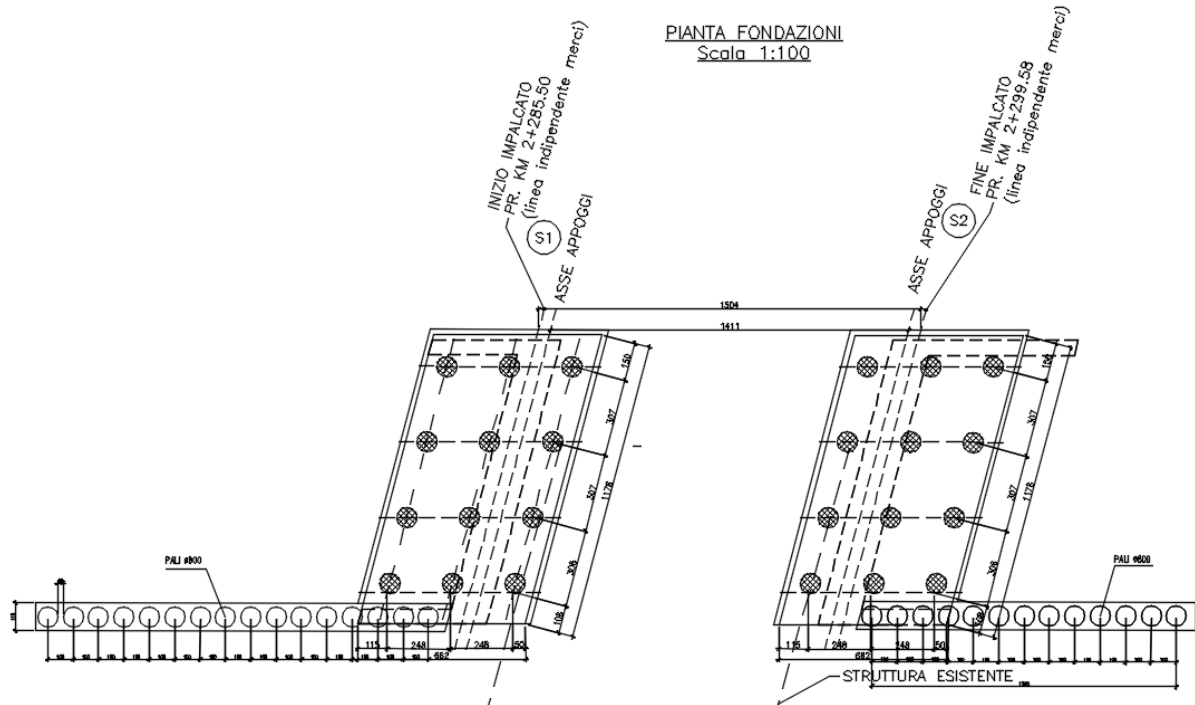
Spalla - Pianta delle fondazioni
